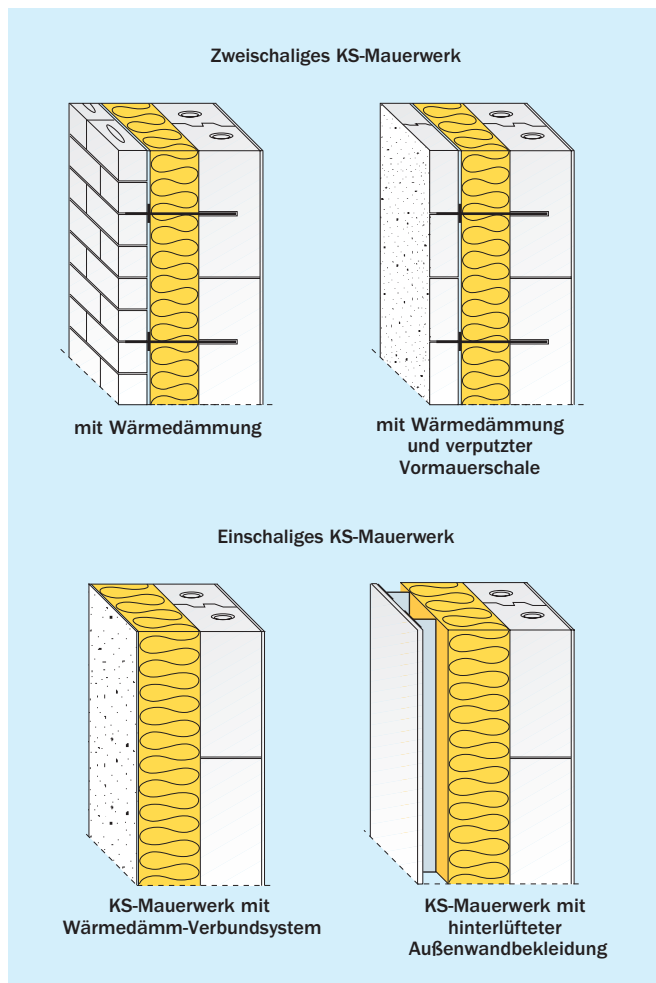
KS-Außenwandkonstruktionen für beheizte Gebäude [9]
